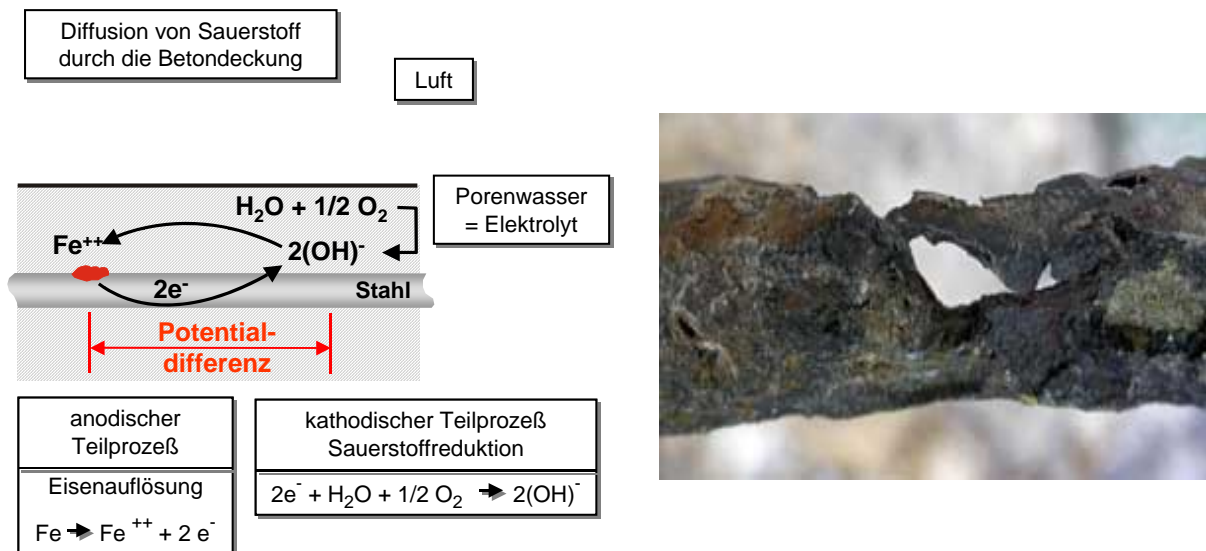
Schematische Darstellung der Korrosion von Betonstahl, links und durch chloridinduzierte Korrosion geschädigter Stahl, rechts /9/, /15/
